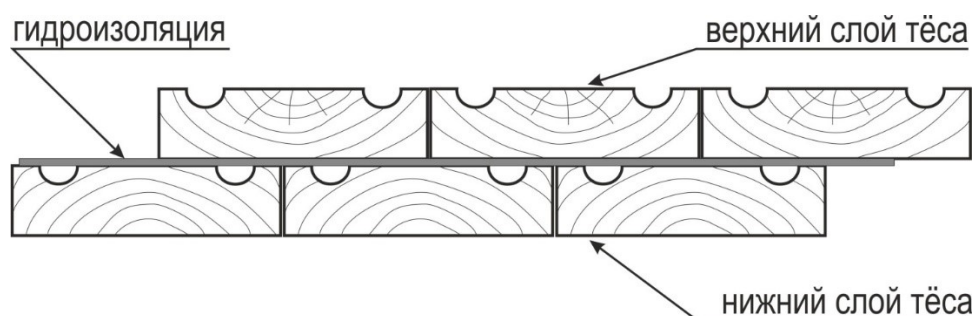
Схема укладки тесовой кровли из дороженного теса
